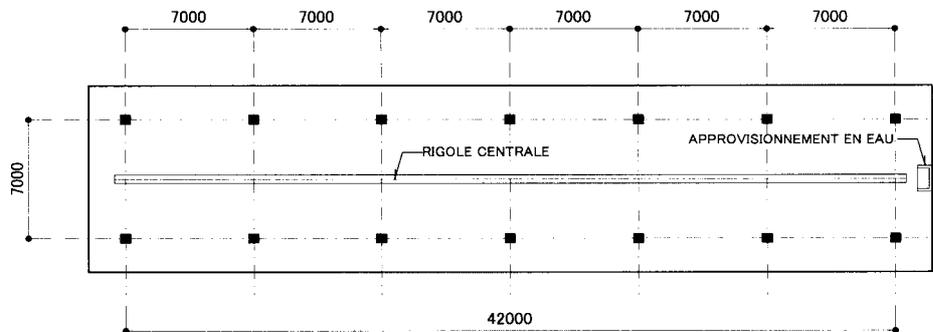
Plan planimétrique de l'aire de débarquement et de triage
